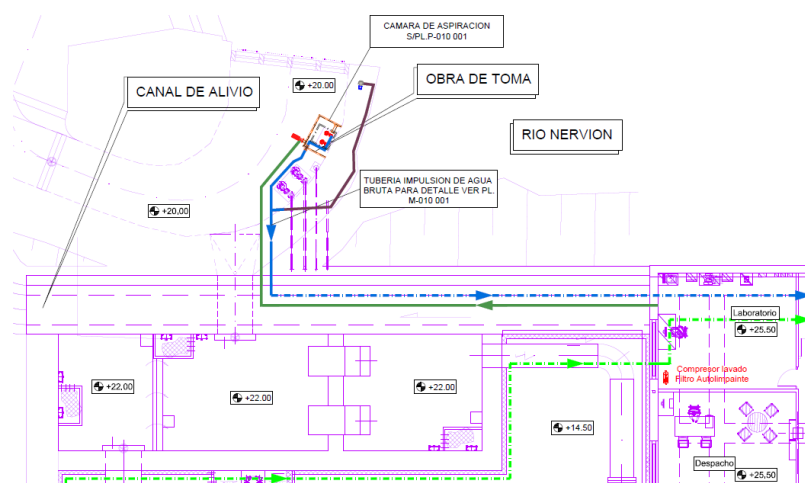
Plano con el recorrido de las bandejas de fuerza y control para la planta piloto, en la ubicación actual
